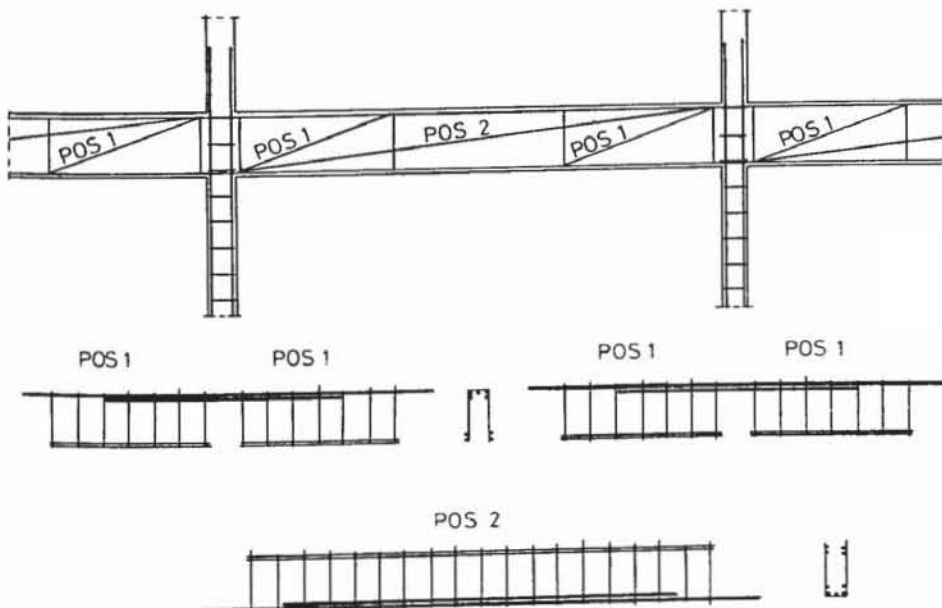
Montage vorgefertigter Bewehrungen mit Staffelung der Schubbewehrung
